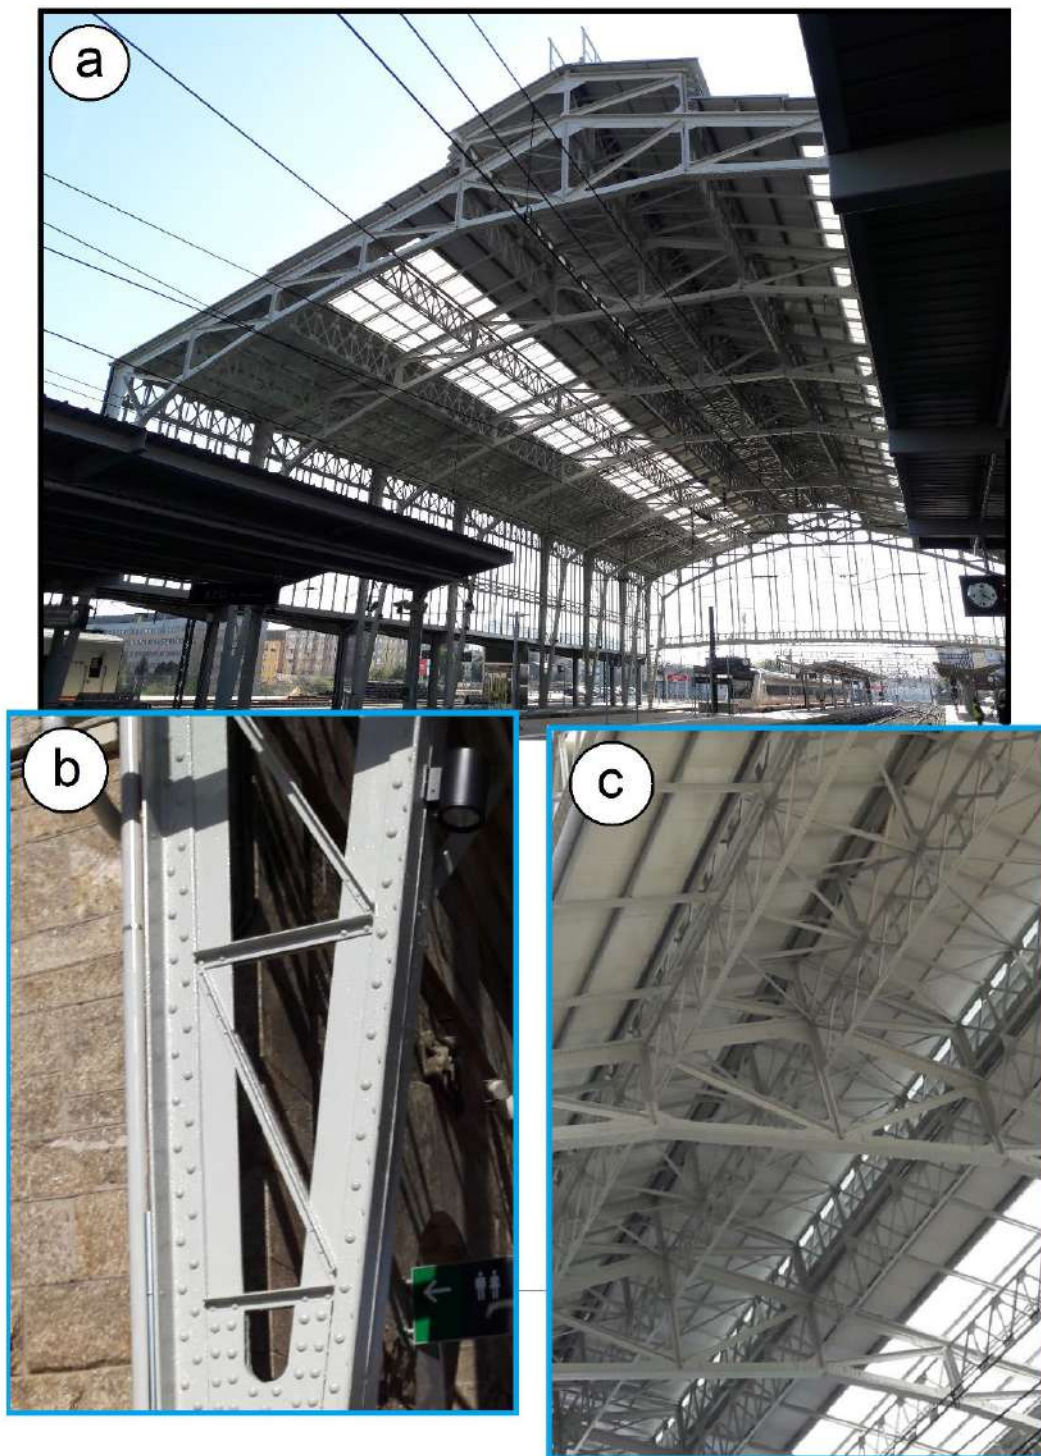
Ejemplo de estructura de acero histórica en uso actualmente como estación de tren. a) Vista general de la estructura de la estación de tren. b) Detalle del roblonado de los perfiles de un pilar. c) Detalle de la celosía de la cubierta.
